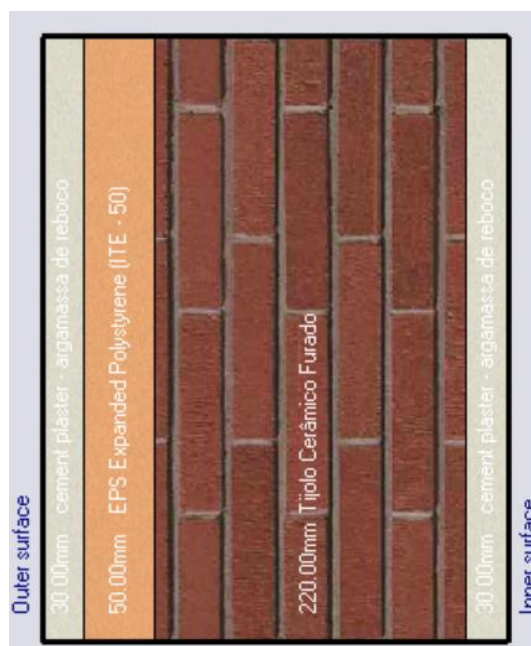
Constituição do exterior para o interior da parede em alvenaria comum.
